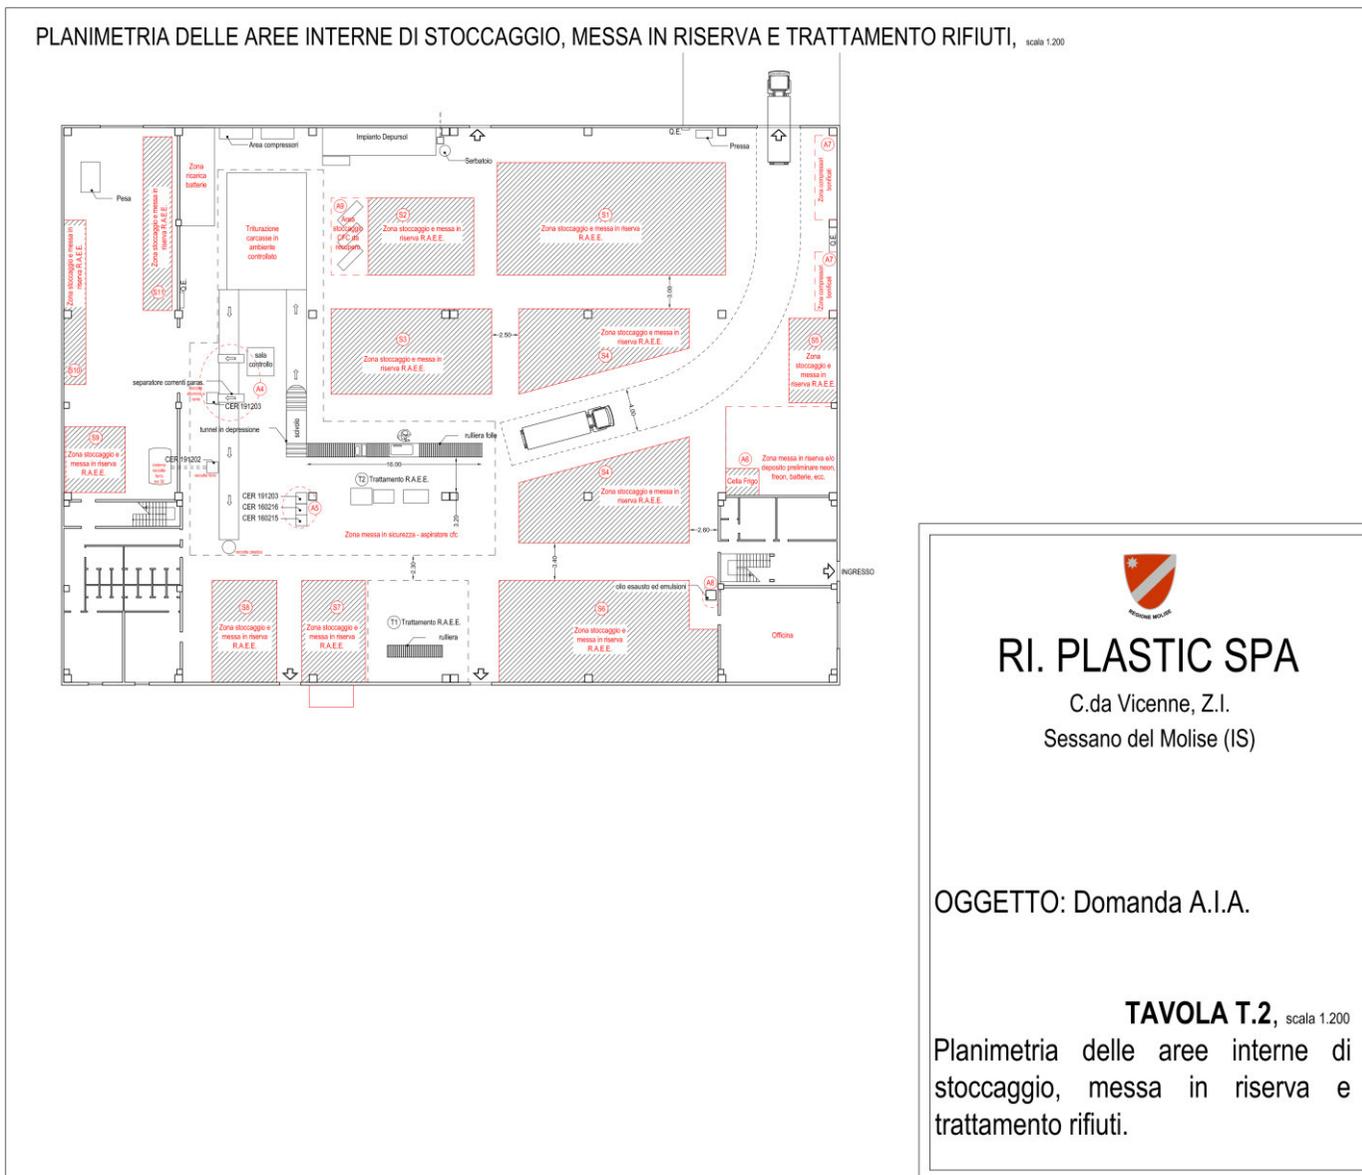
planimetria generale delle aree interne dell'installazione: assetto "ante operam"
